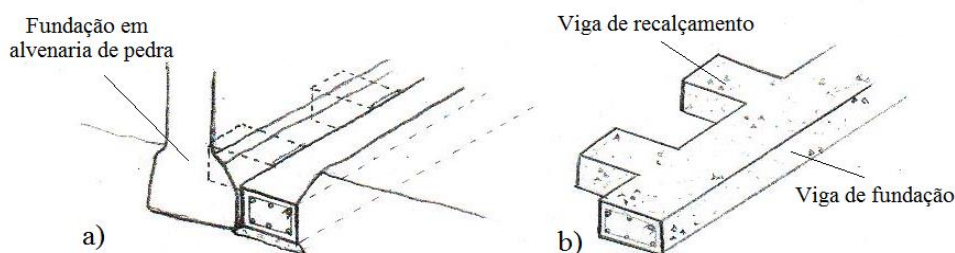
Reforço exterior da fundação com viga de fundação em betão armado, a) Pormenor do atravessamento das vigas perpendiculares, b) Pormenor da viga de fundação, (Fonte: de autor)
